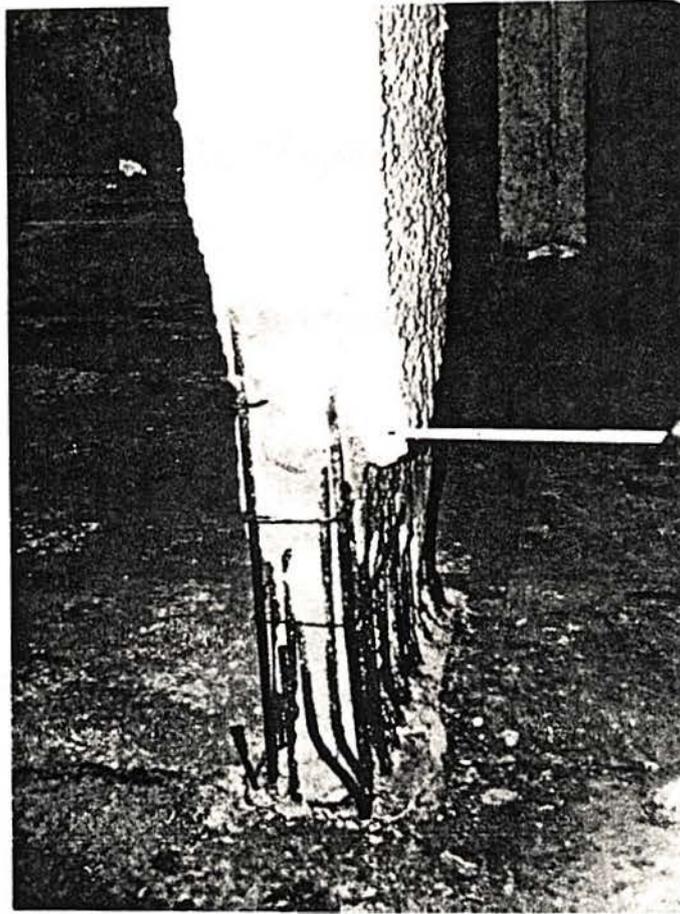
Corrosão das armaduras, esperas "caneladas" e com cobrimento em desacordo ao projeto estrutural
